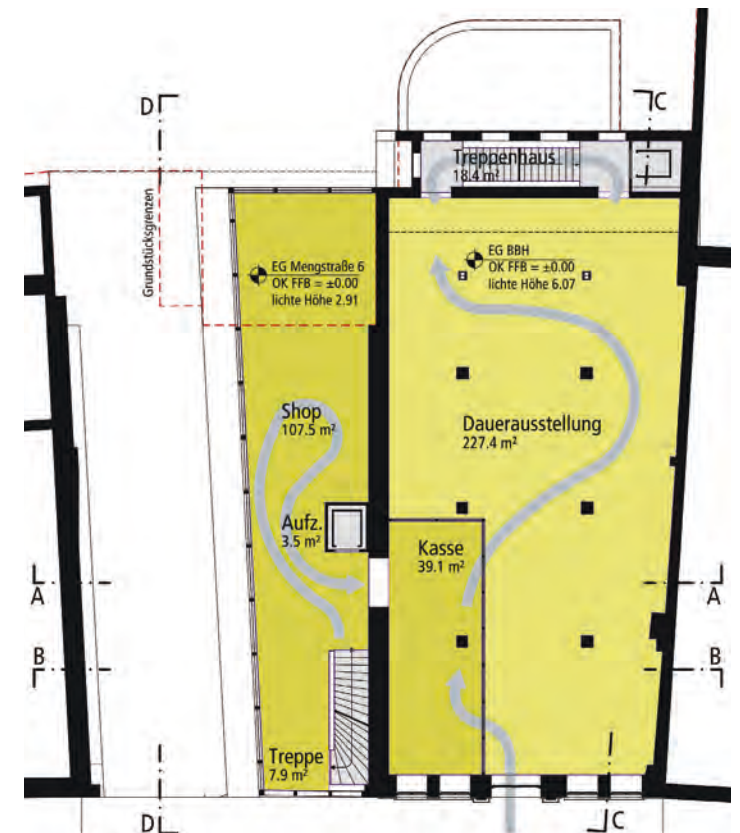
Variante 1, Grundriss Erdgeschoss
